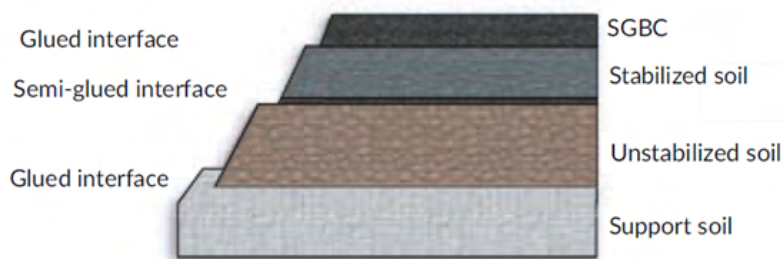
Coupe d'une structure de chaussée semi-rigide
